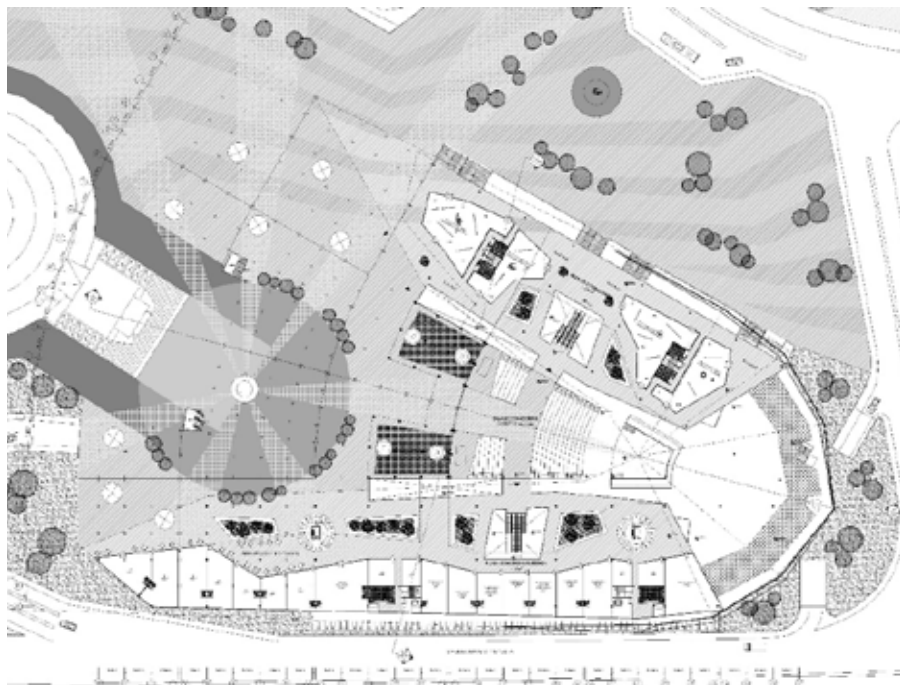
Planta Uno. Nivel ±10.20m. (2016)
